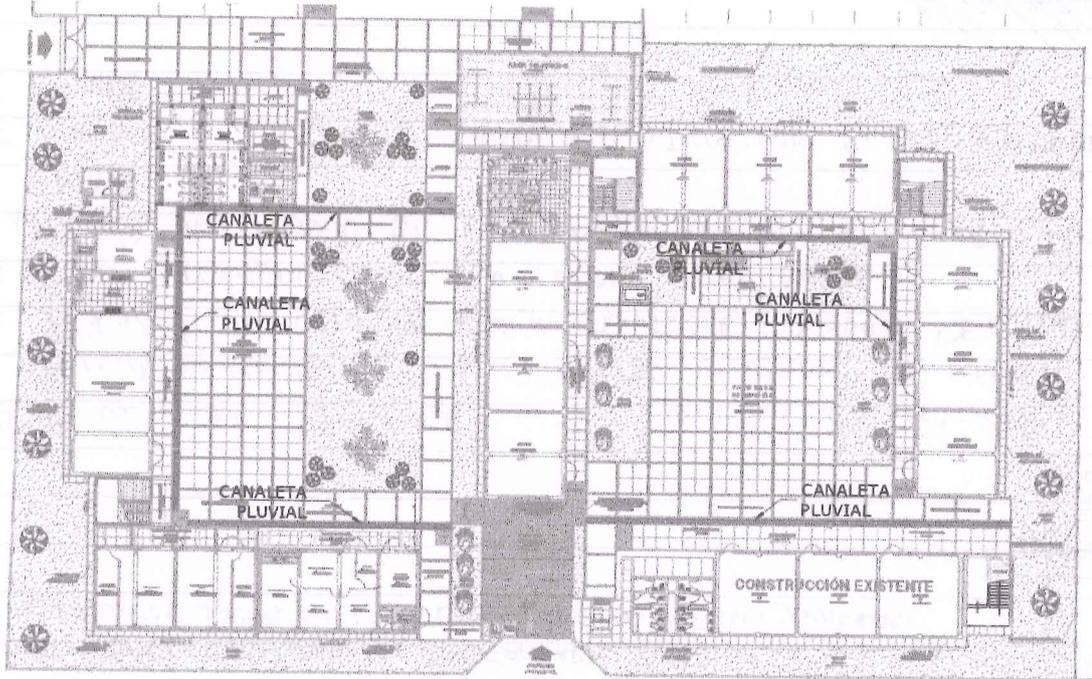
Vista en planta de la I.E. N 81032 de la localidad de Guadalupe en donde se aprecia la proyección de canaletas de drenaje pluvial.
